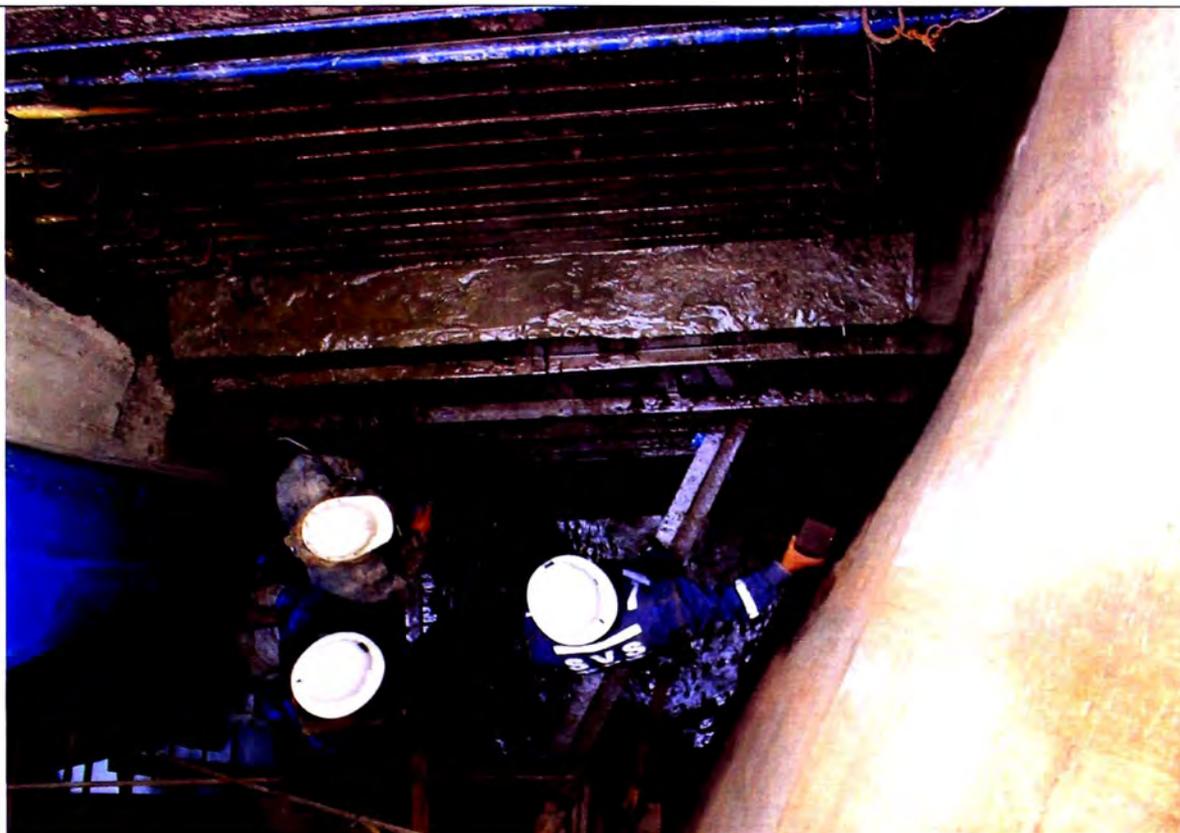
Desencofrado del Muro M1 en Ventana N° 12.
